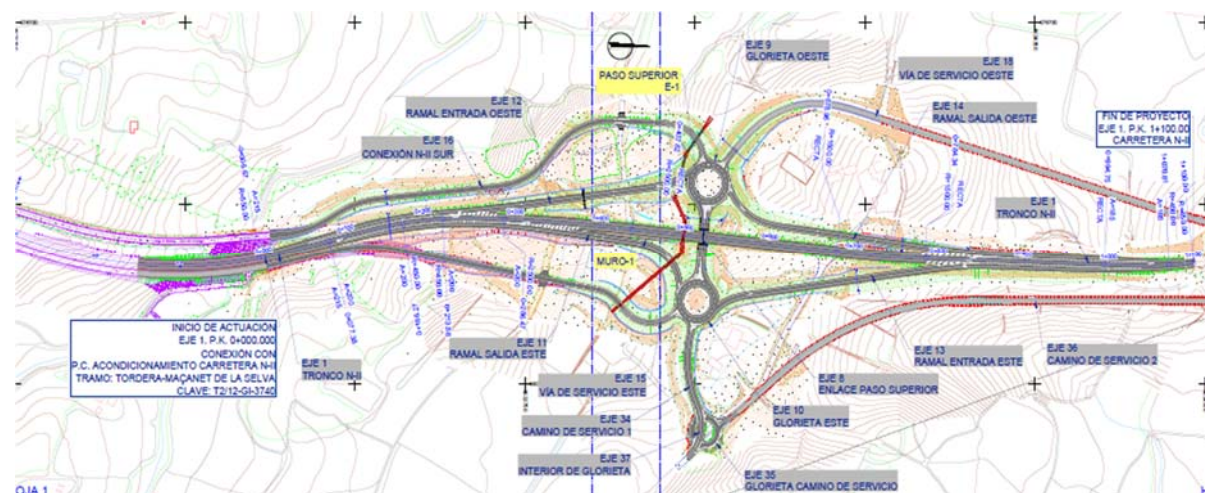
Detalle de conexión con el tramo previo. Proyecto de Clave:12-GI-3740
